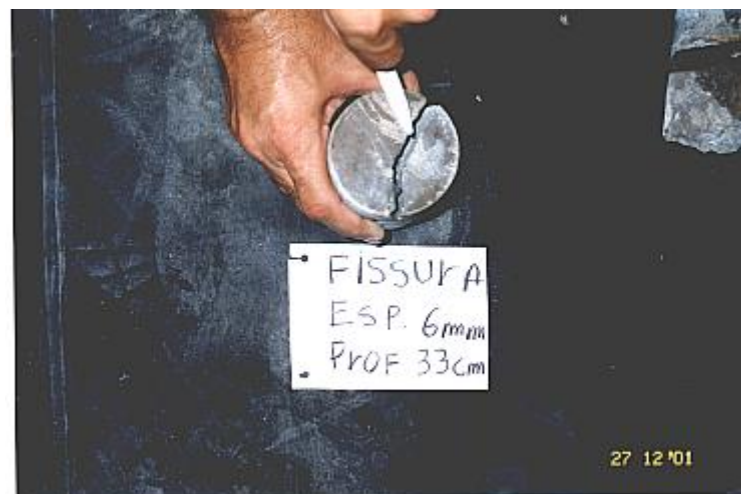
Testemunho extraído do Bloco 7. Detalhe da fissura na superfície.
